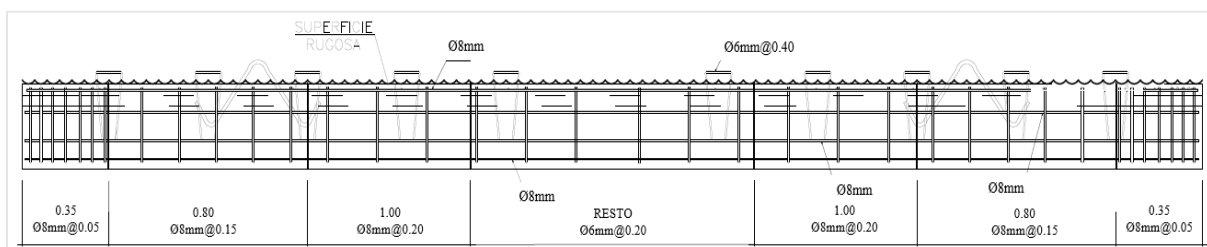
Desarrollo de losa TT30 – espaciamiento de estribos.
